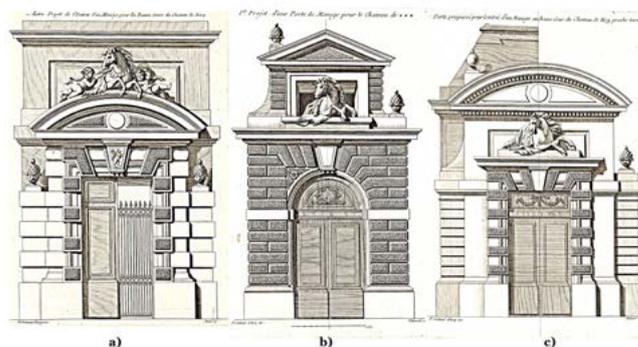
Pierre Contant d'Ivry planchas de *Les Oeuvres d'architecture* de Pierre Contant d'Ivry, architecte du Roi. (1769); Lámina 25; b) Lámina. 29; c) Lámina 52.
